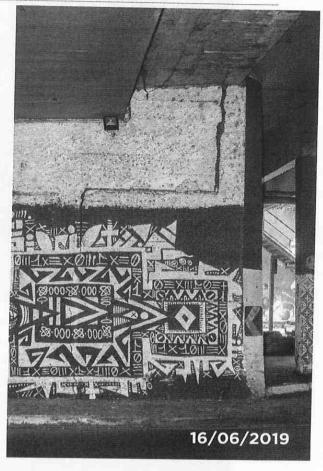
Vista da trinca entre o muro de arrimo e a estrutura do viaduto.
